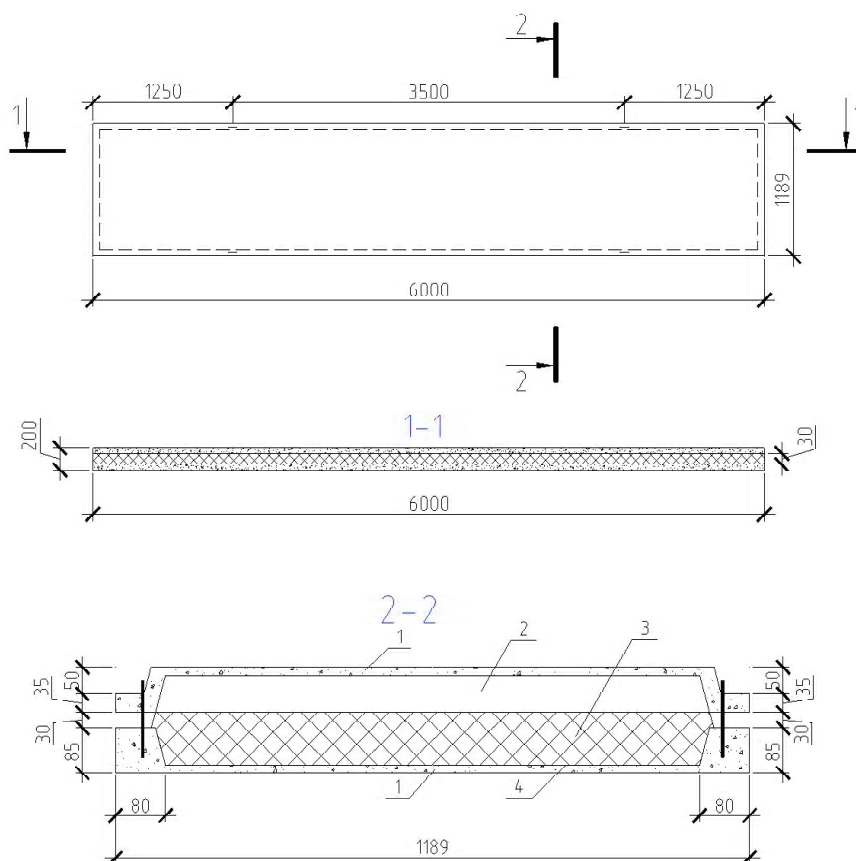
Комплексная панель покрытия из ребристых плит, армированных фиброкаркасами: 1 – сталефибробетонная плита толщиной 15 мм; 2 – воздушная прослойка; 3 – минеральная вата; 4 – пароизоляция.
